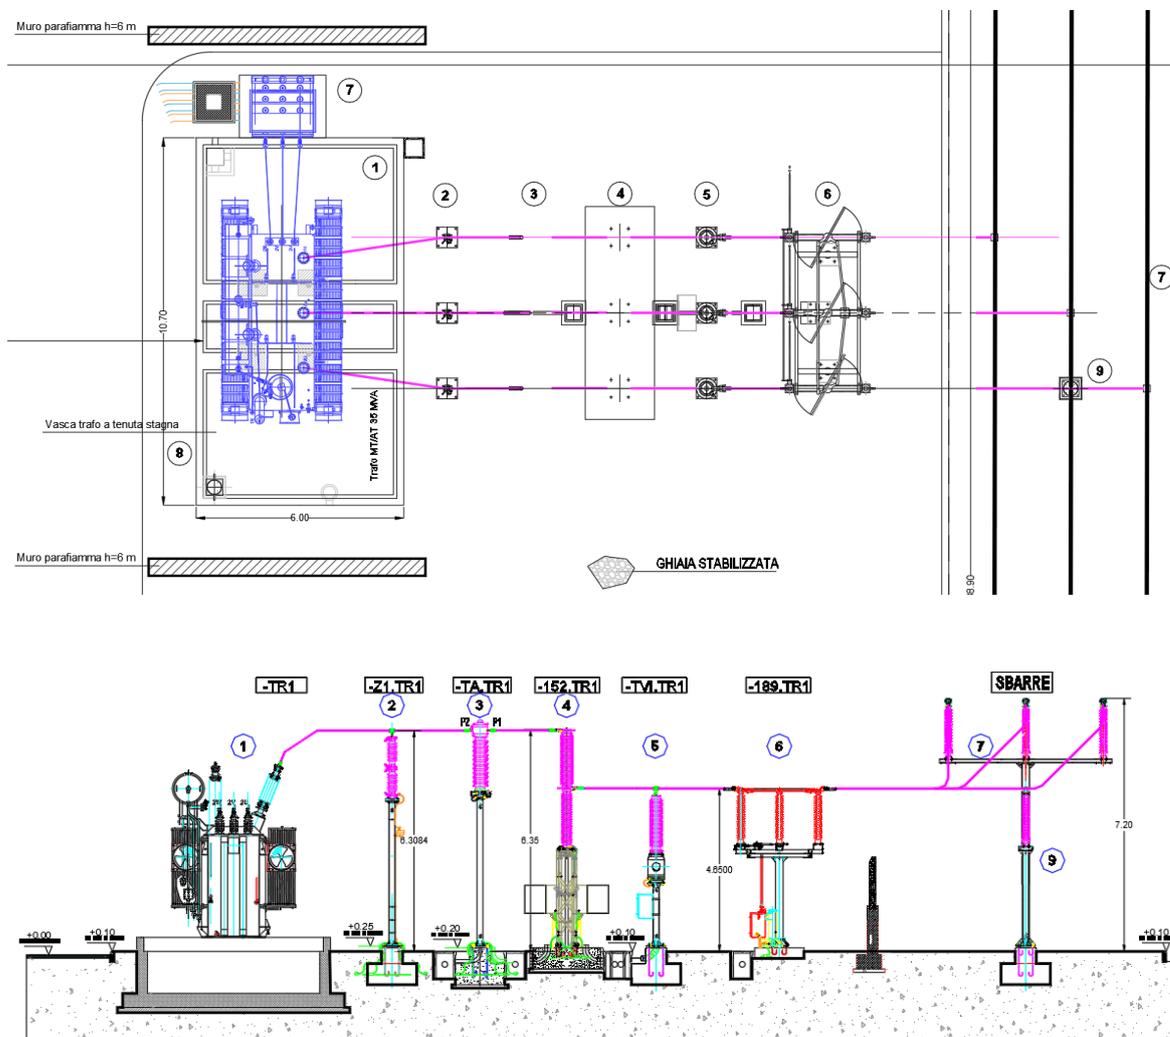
LAYOUT APPARECCHIATURE STAZIONE SSE
